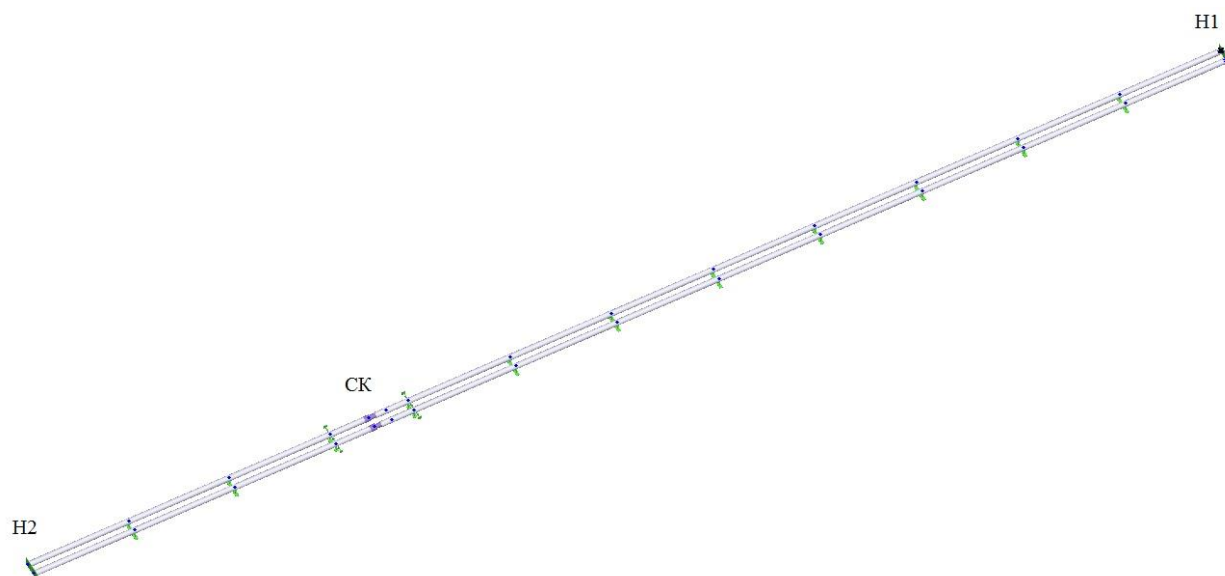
Прокладка трубопроводов в канале со смещением сильфона
